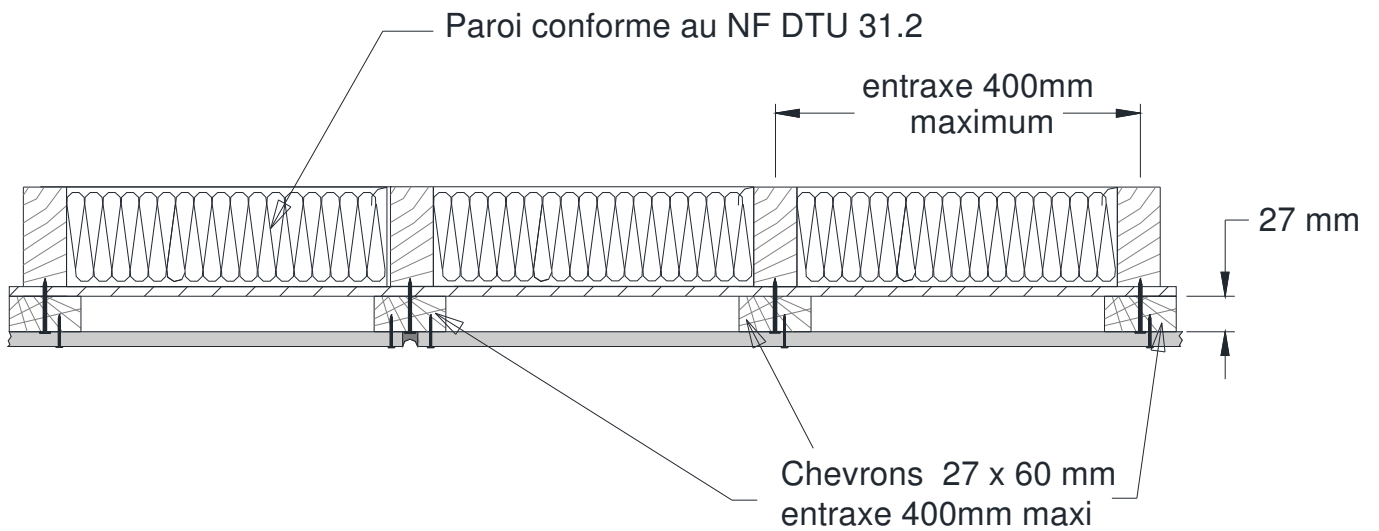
Coupe horizontale sur COB – Pose horizontale (entraxe 400 mm maxi)
